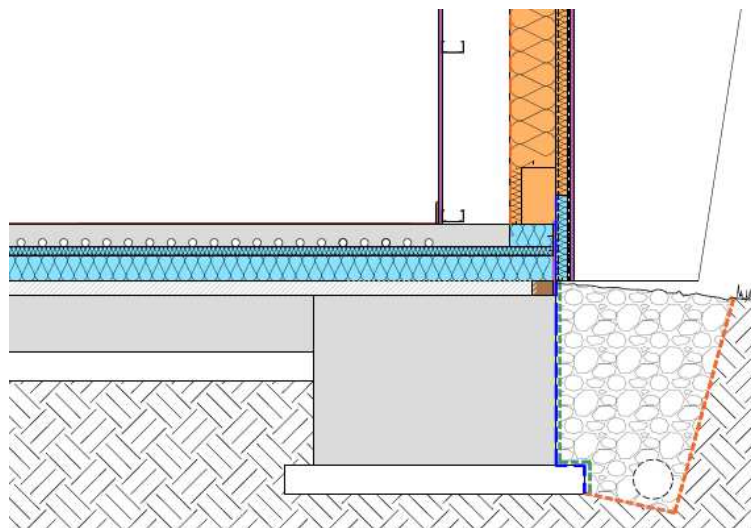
particolare della stratigrafia pavimentazione della palestra
